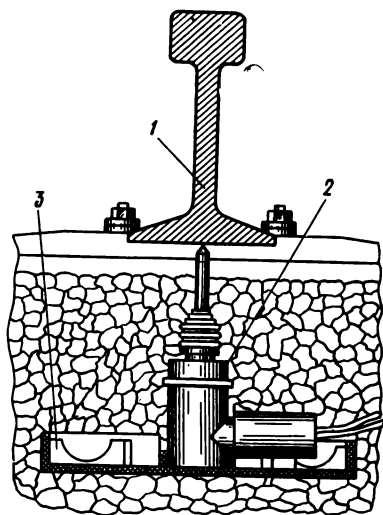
Установка исполнительного механизма ПВУ-79 под рельс:
